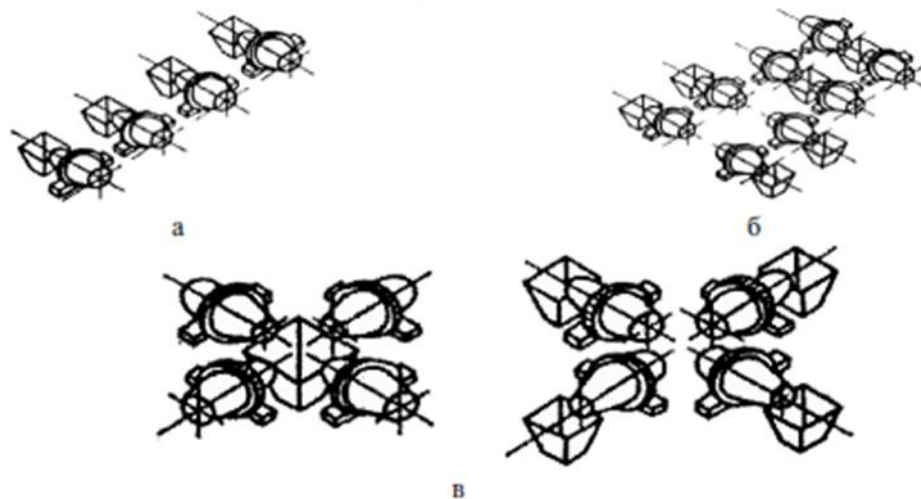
Схема вертикального планування бетонозмішувальних установок
